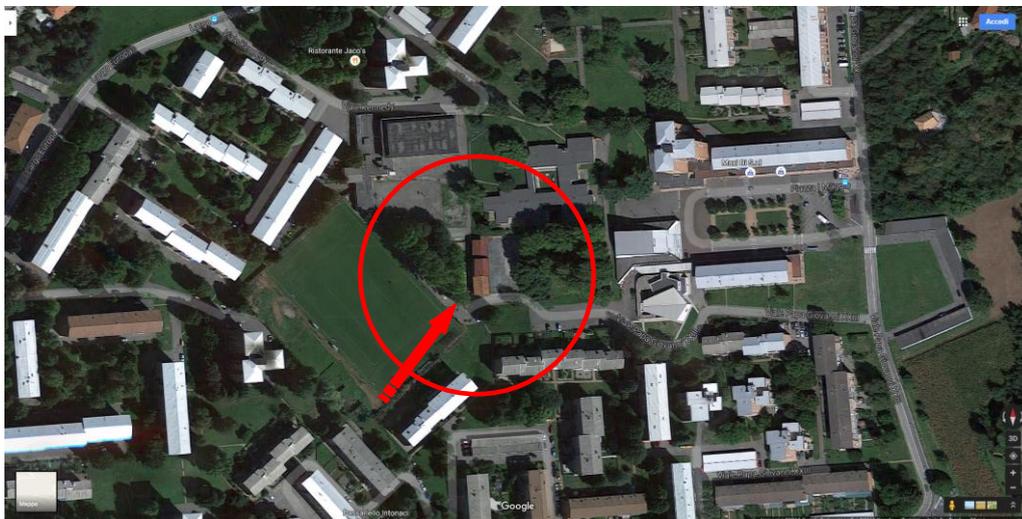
Vista aerea dell'area oggetto dell'intervento con individuazione dell'edificio esistente ed indicazione dell'accesso all'area di cantiere ed ai futuri
